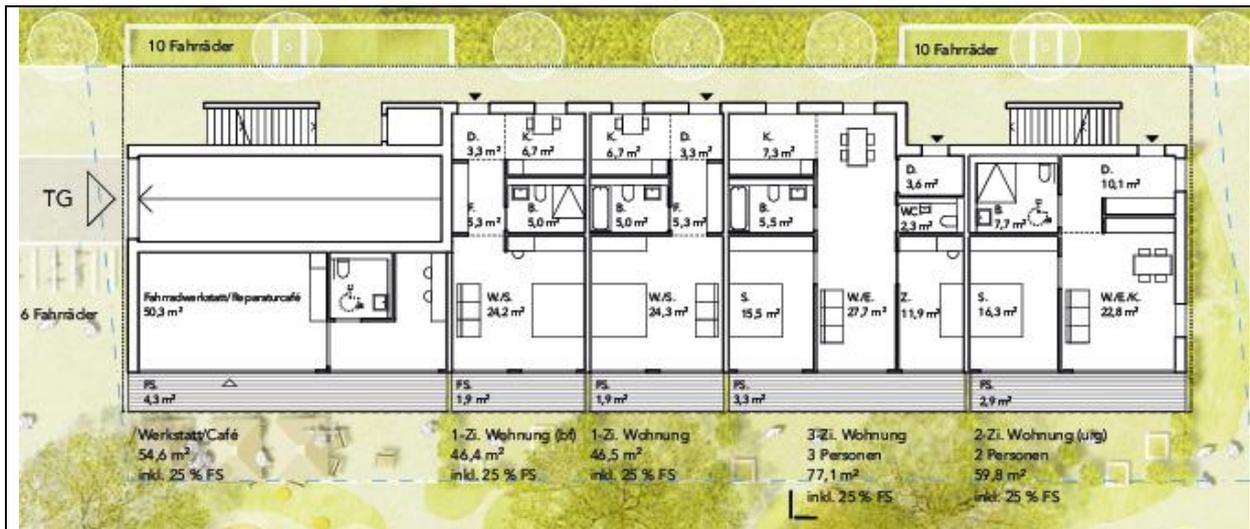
Grundriss EG westlicher Riegelbau mit Tiefgaragenzufahrt und Café
